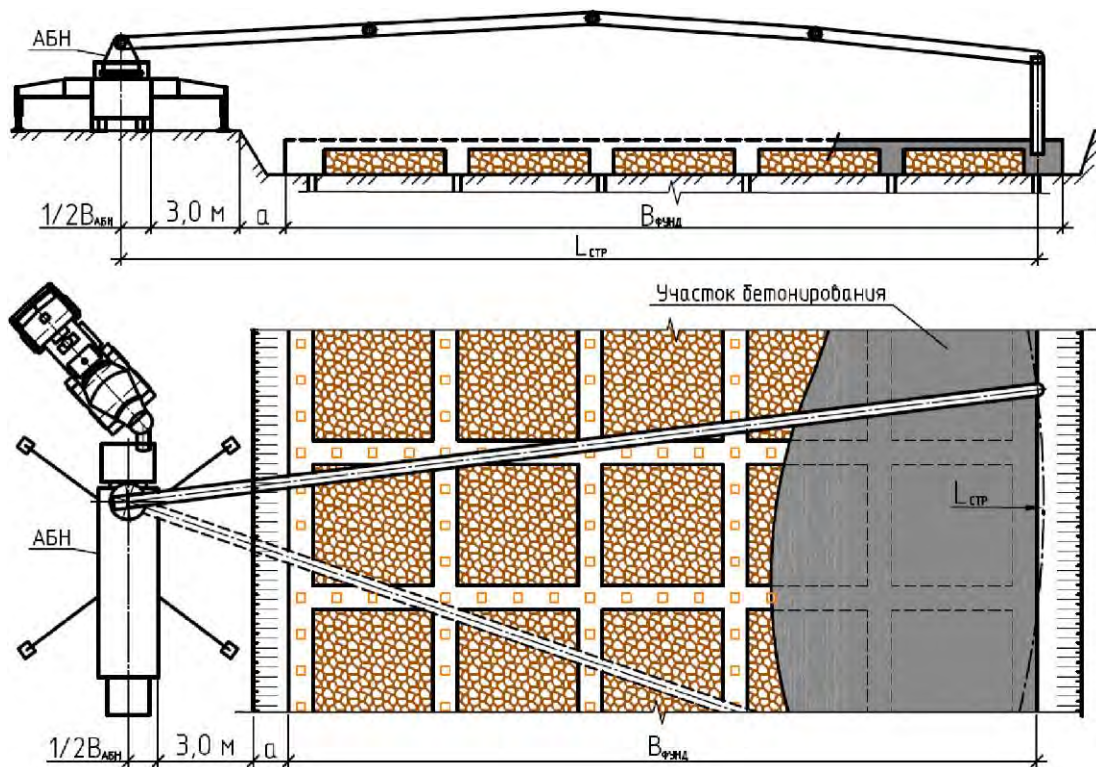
Організаційна схема бетонування КСПФ автобетононасосом
